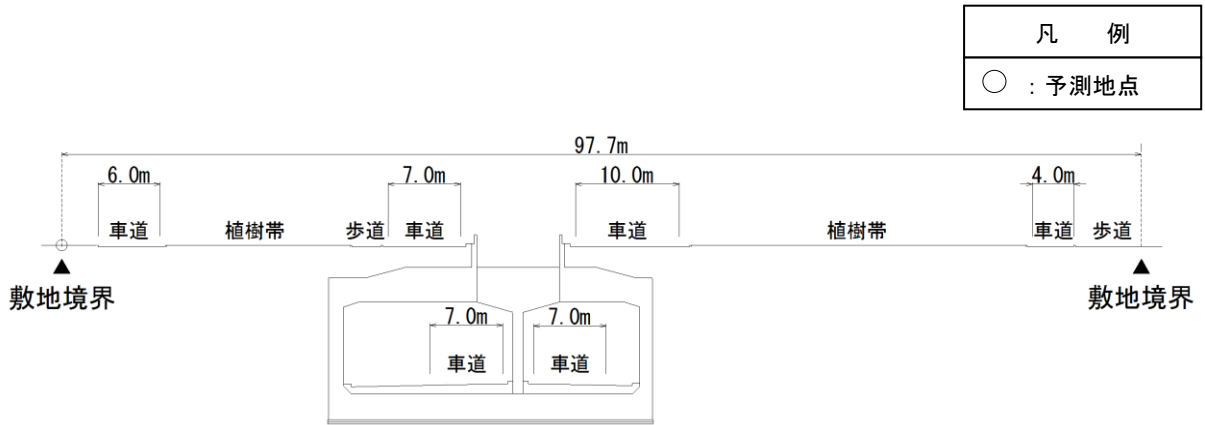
(1) 予測断面图 (A. 一般国道298号/東京外かく環状道路)
